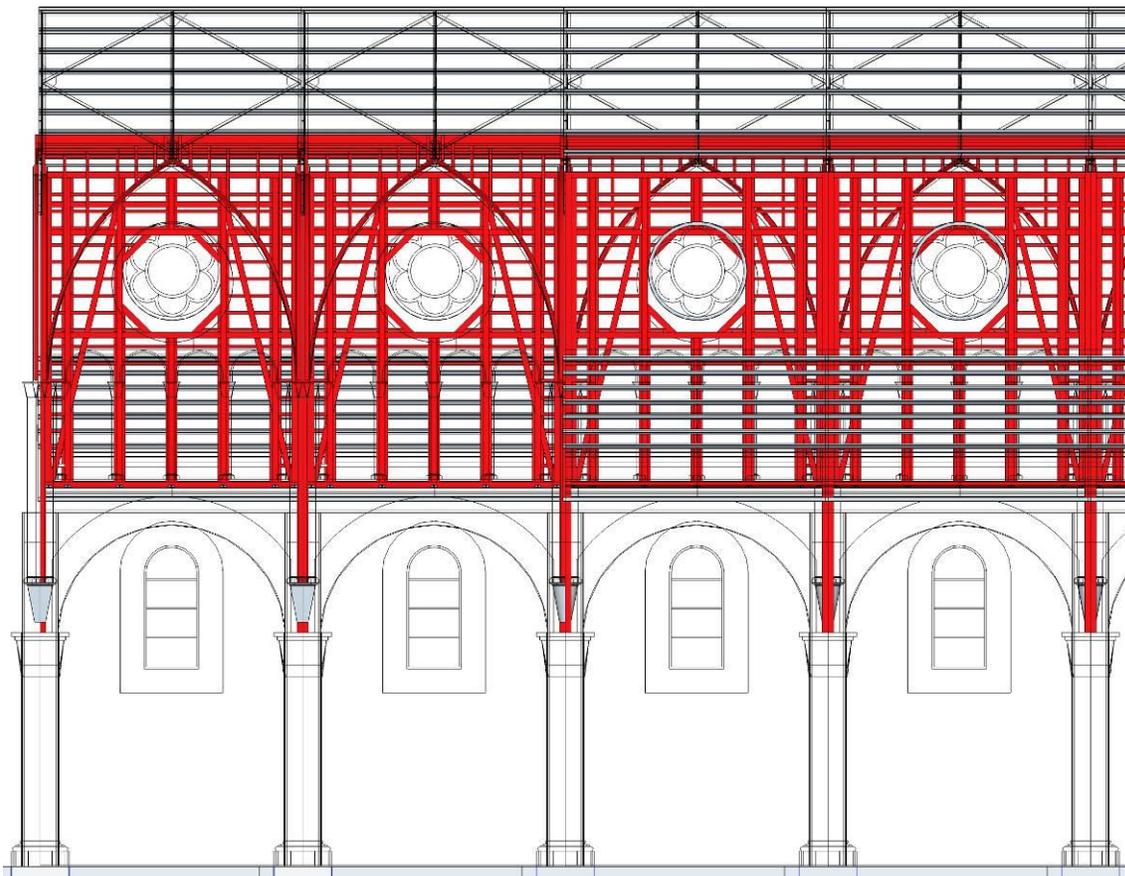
Elevación esquema de estructuras de madera en naves, en rojo, Elab. propia.
